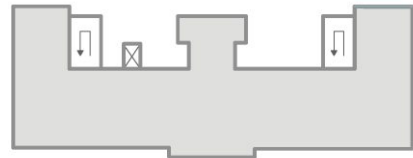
Schema Adaptierung und Erweiterung: Grundriss Erdgeschoß.
